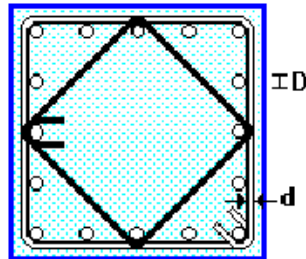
Diámetro mínimo para armadura longitudinal y de estribos en una columna.
